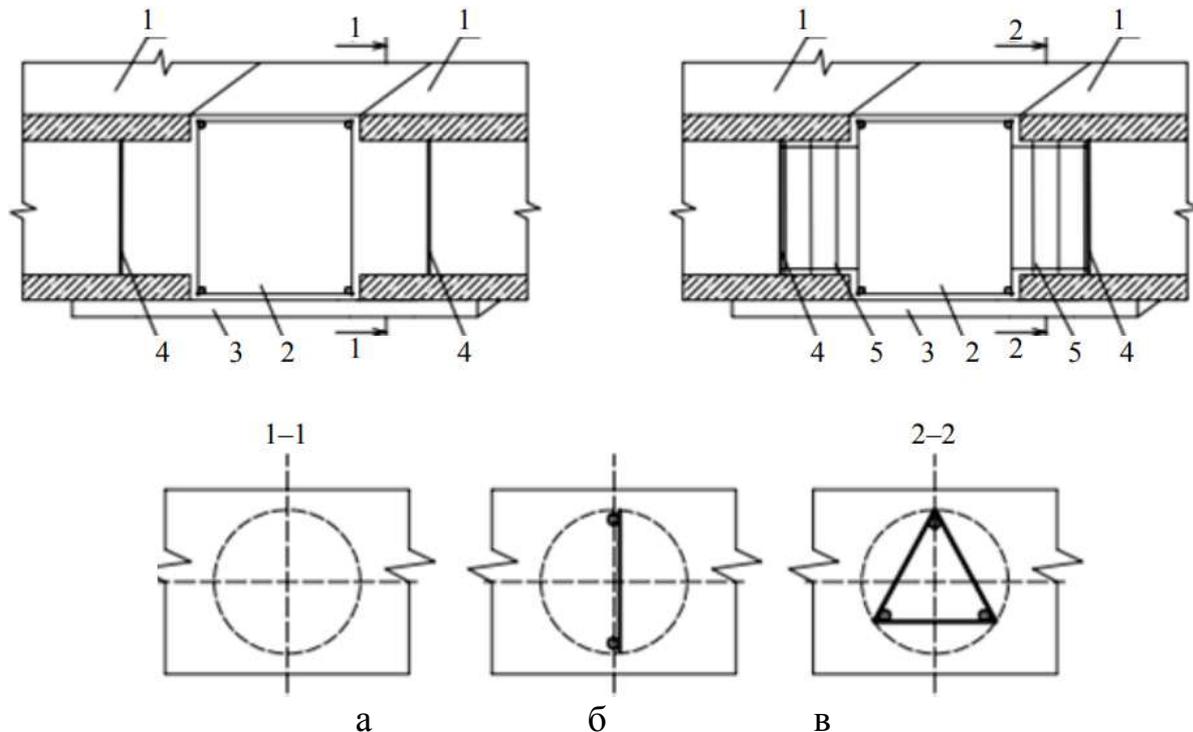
Вузол обпирання багатопустотних плит на монолітний ригель збірно-монолітного перекриття шляхом бетонних шпонок (а), армованих плоскими (б) та просторовими (в) каркасами у вигляді порожнистої призми з трикутною основою: 1 – багатопустотна плита; 2 – ригель; 3 – опалубка; 4 – арматурний каркас шпонки; 5 – заглушка для обмеження глибини шпонки
